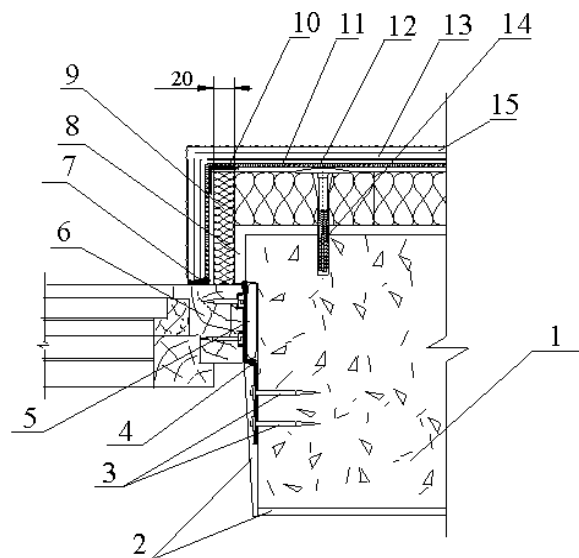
Фрагмент утепления вертикального откоса оконного проема.
